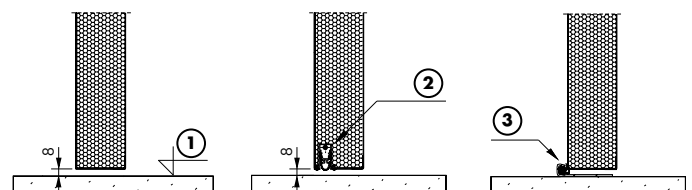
Vložená zárubeň s přerušným tepelným mostem
